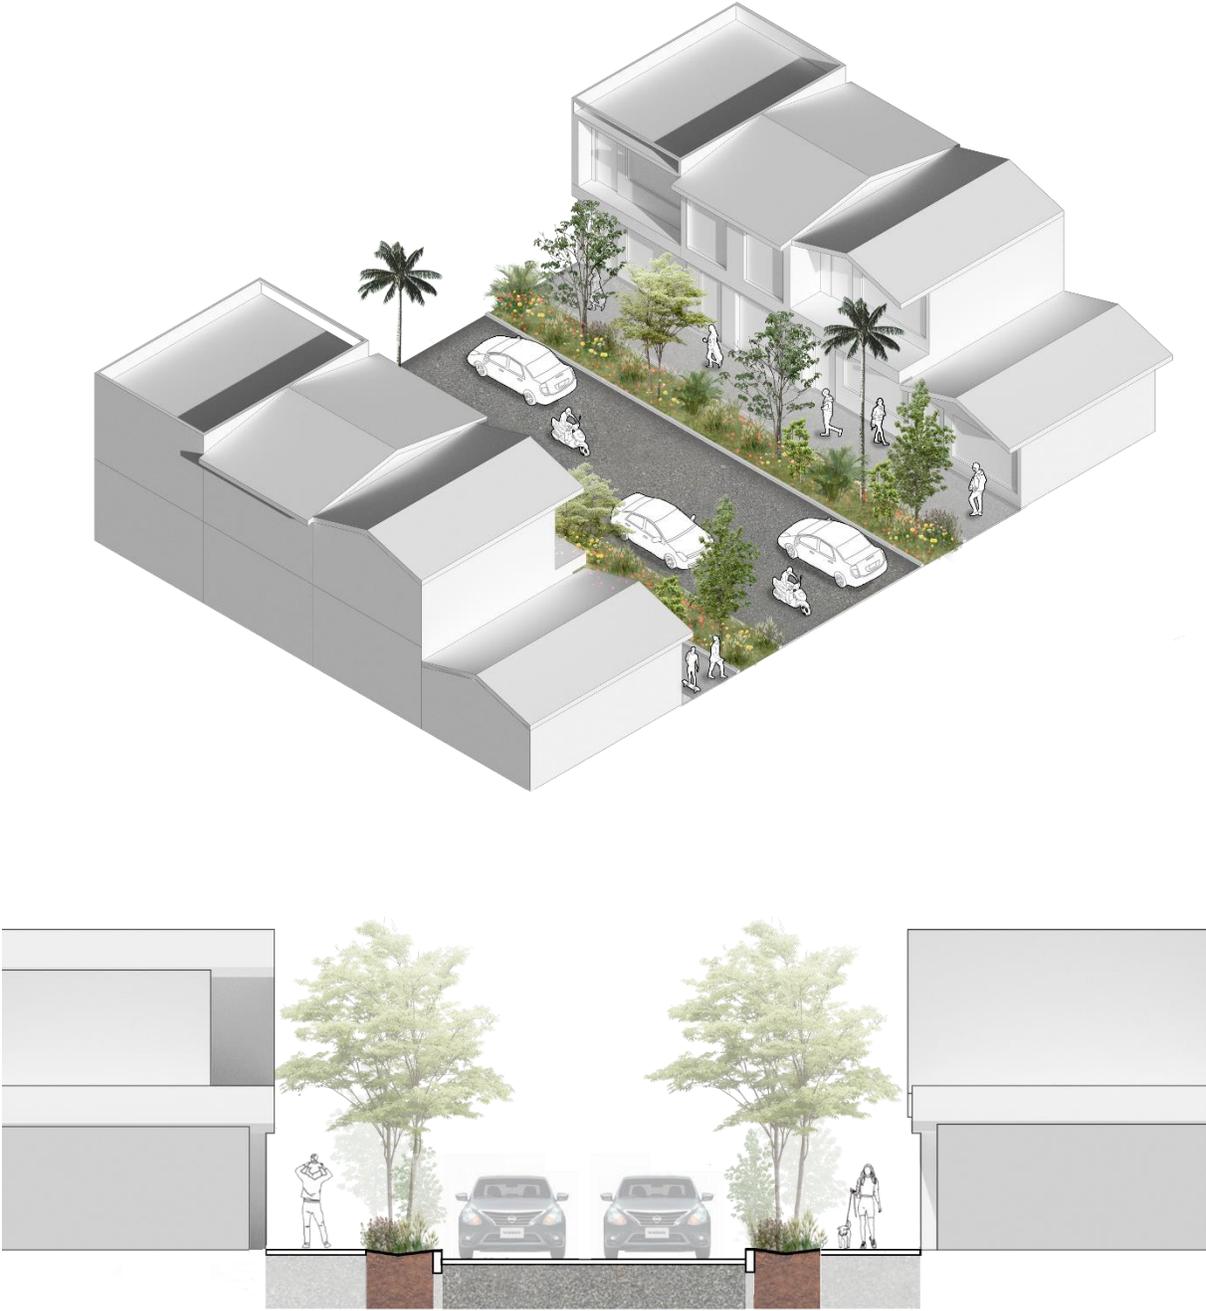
Calle Local Tipo 3 - Axonometría y Sección de Propuesta
